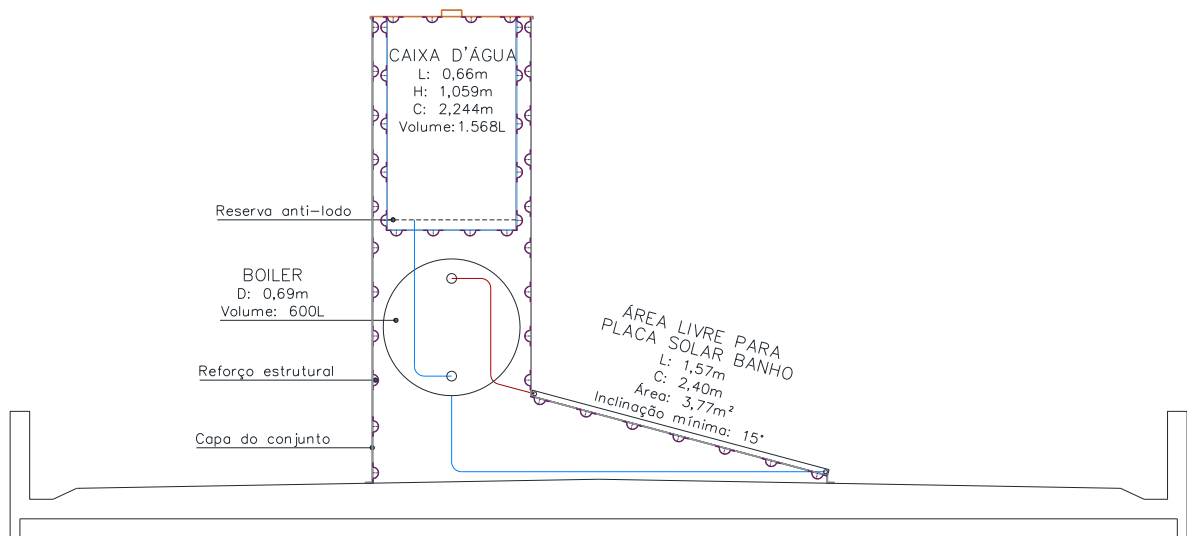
Corte esquemático do núcleo central sobre o módulo de cobertura
